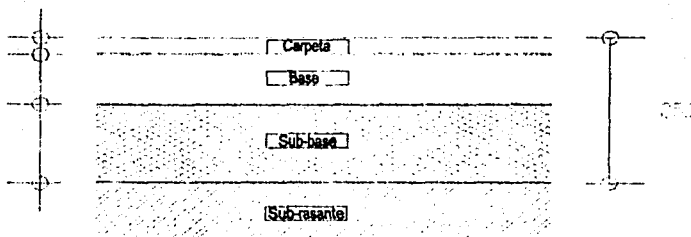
Estimación de espesores para pavimento flexible, zona no crítica, orilla de pista.
